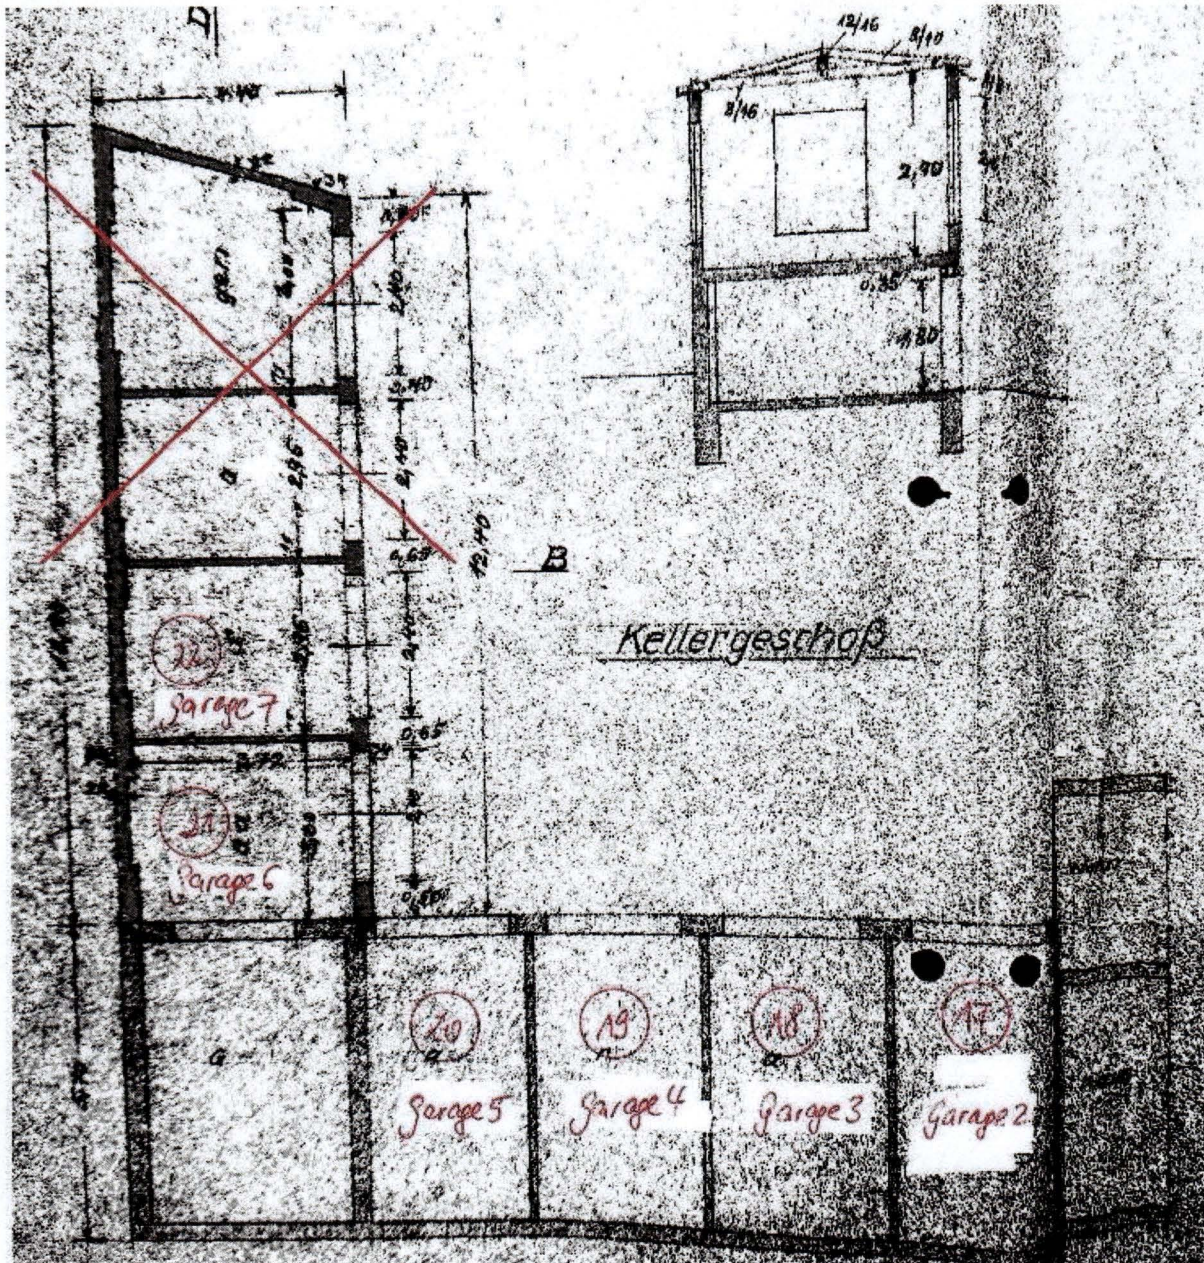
Grundriss Garagen 2 bis 7 (KG, hofseitig), Schnitt Garage 7
